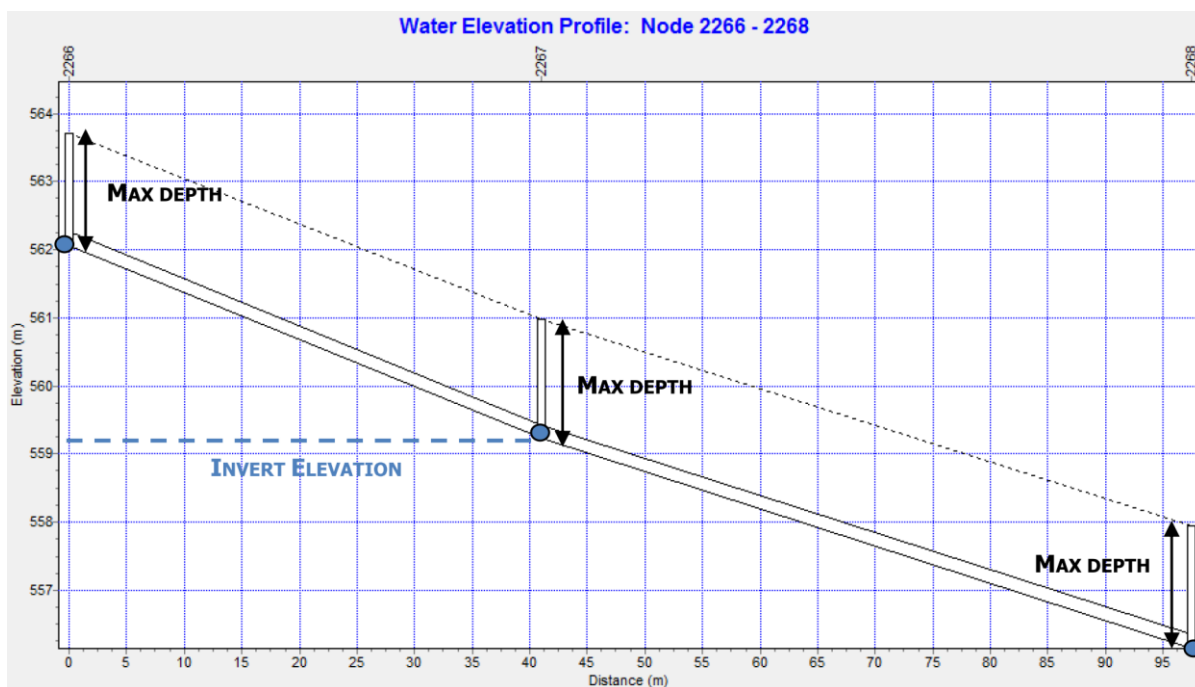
Exemple d'un profil en long illustrant les caractéristiques d'un nœud
